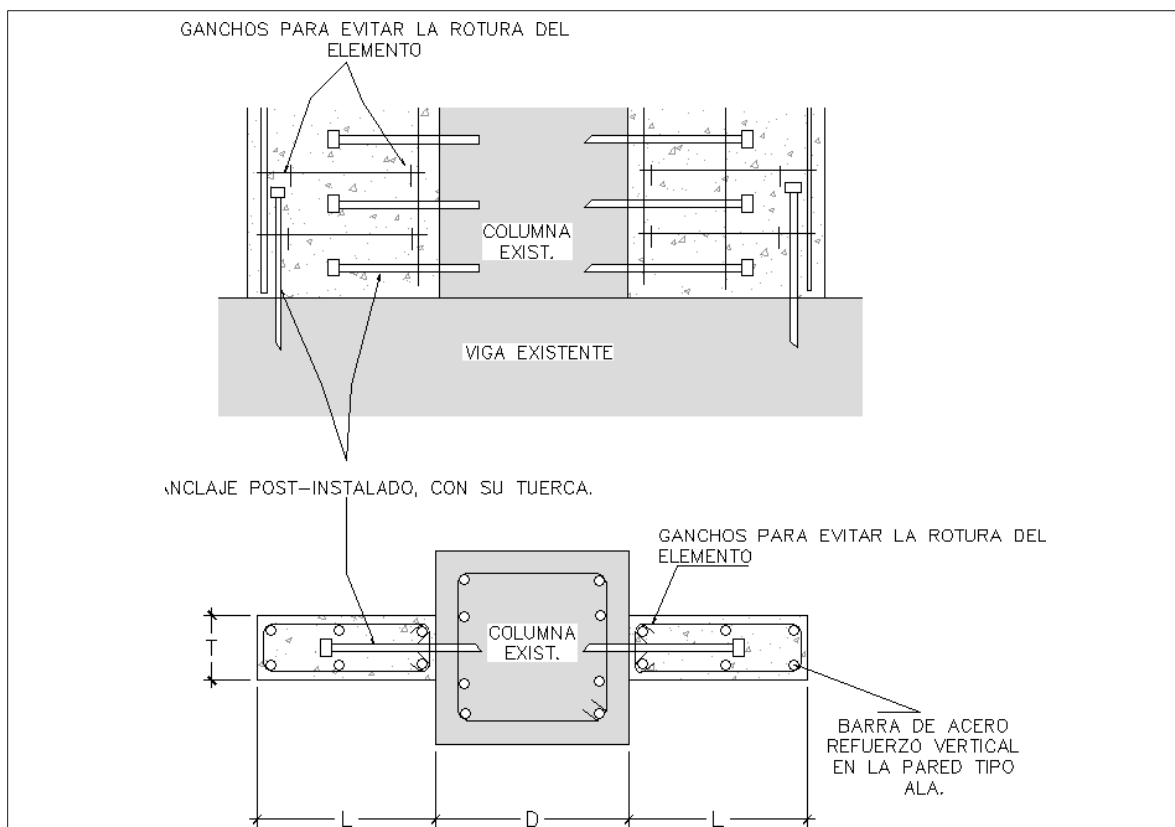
Detalle típico de reforzamiento por medio de pared tipo ala.
